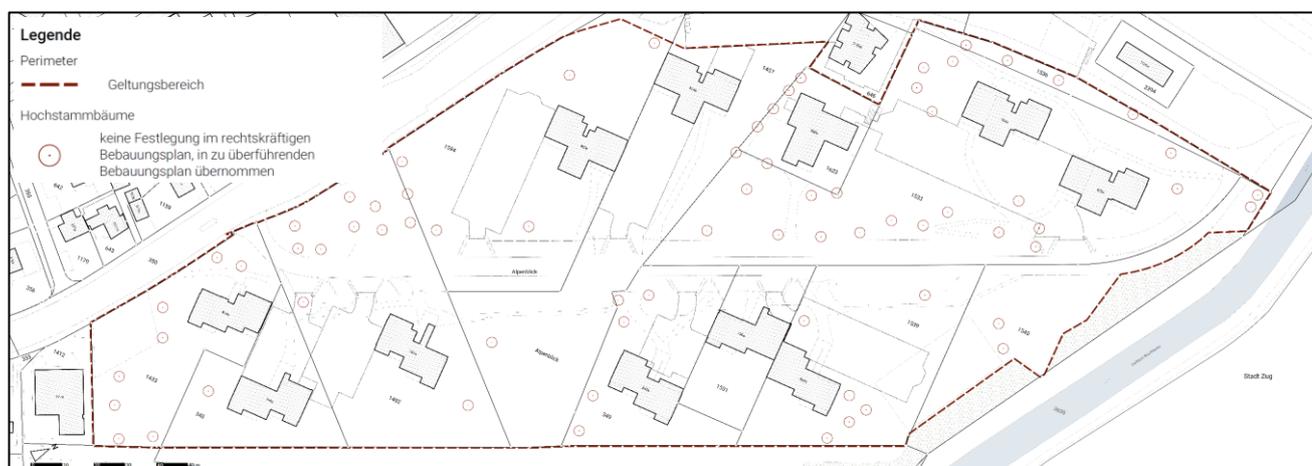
Differenzplan Hochstammbäume Alpenblick. Vergleich rechtskräftiger und überführter Bebauungsplan
